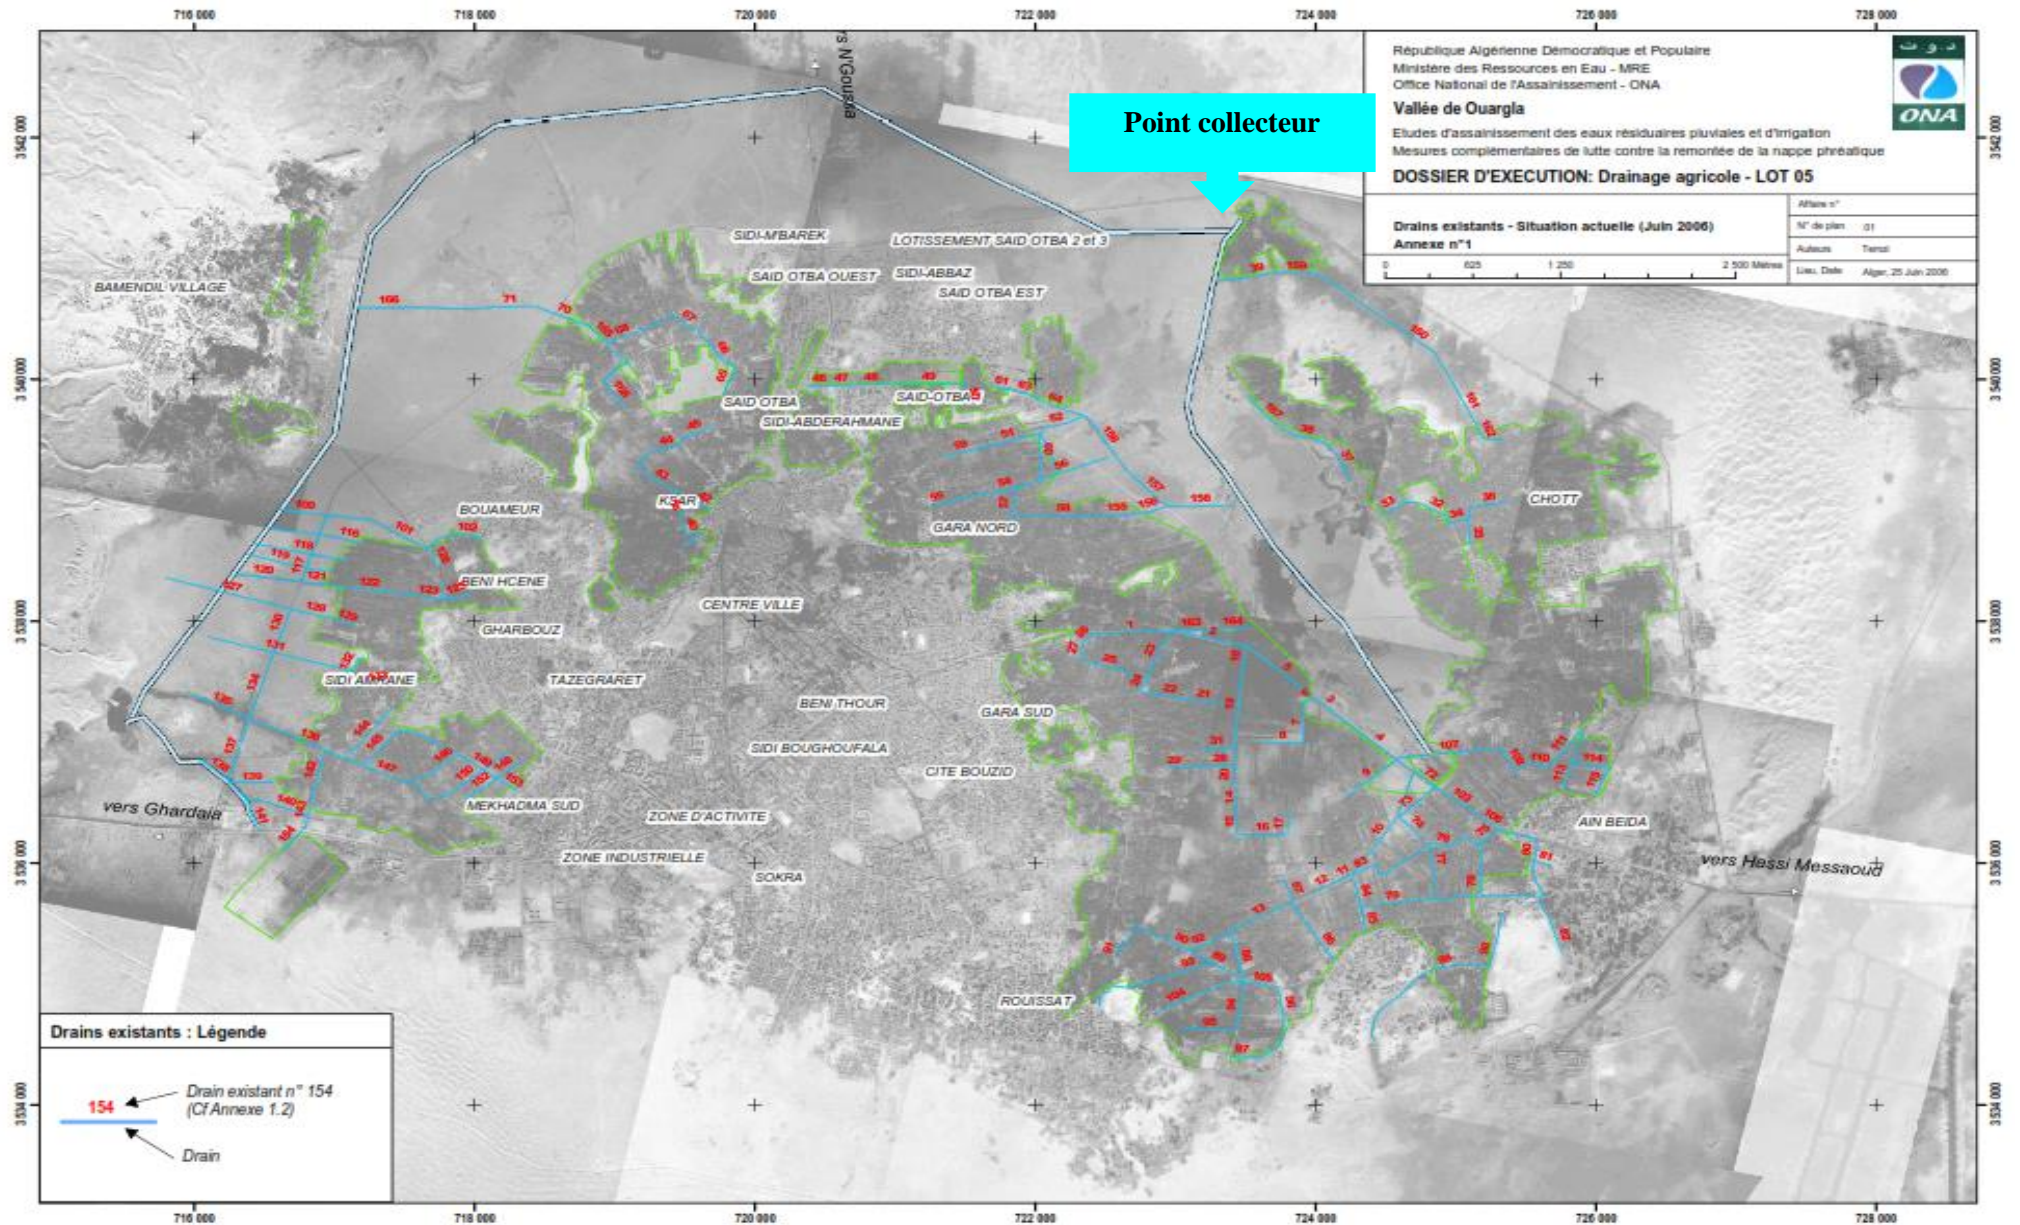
Plan du système de drainage à Ouargla (ONA, 2006)
